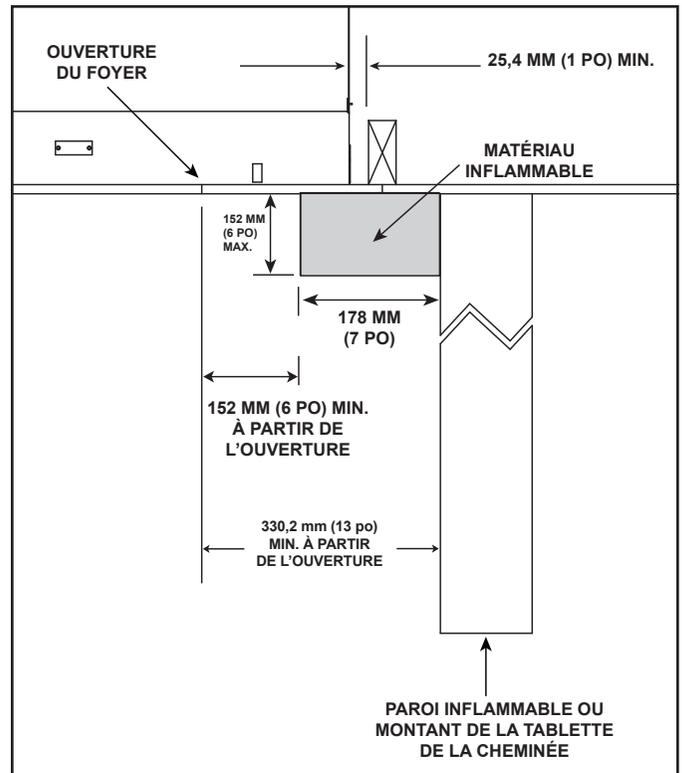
Dégagements par rapport aux pieds de la tablette de cheminée ou saillies du mur inflammable.
